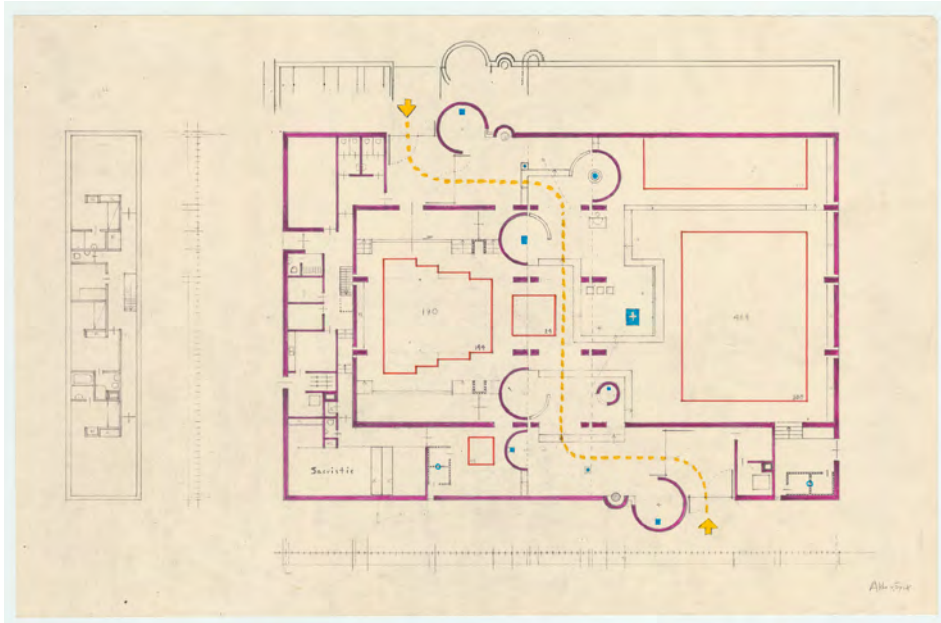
Plano 6A.1. Planta cota cero y planta de cubierta (detalle de la planta de cubierta).
